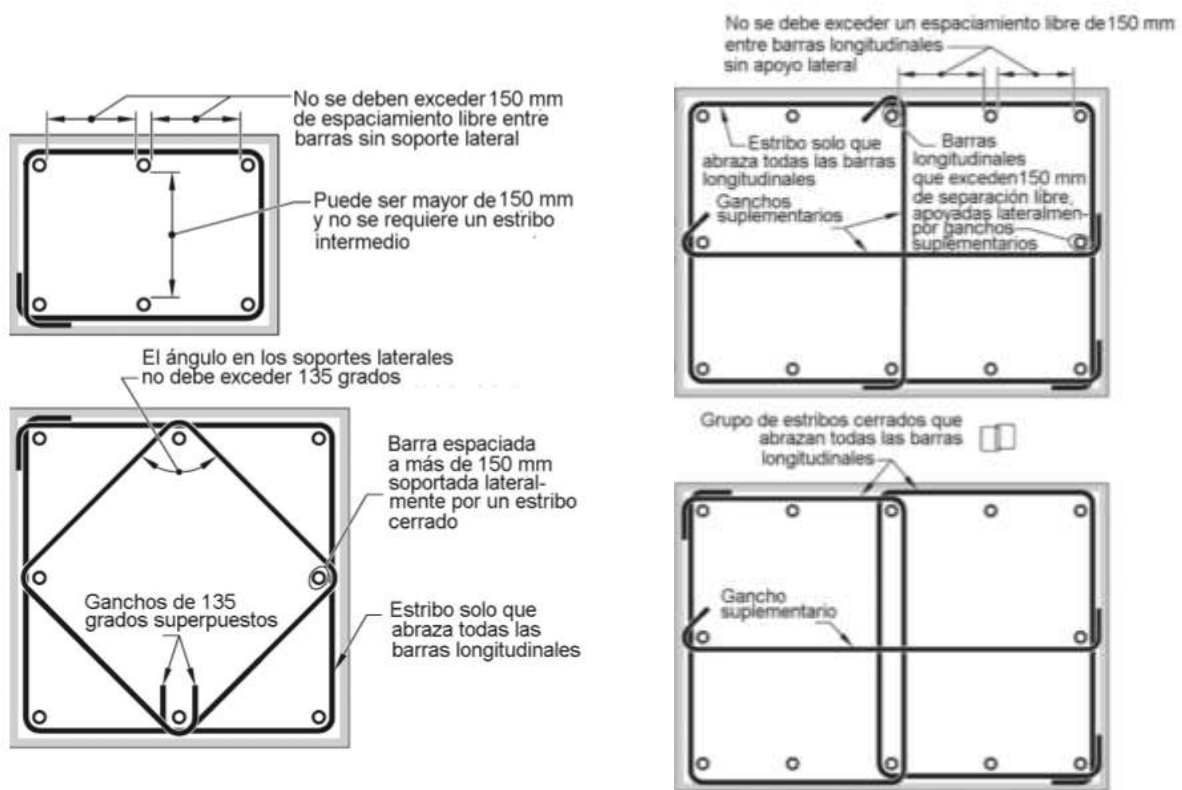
CROQUIS BARRAS DE COLUMNAS
